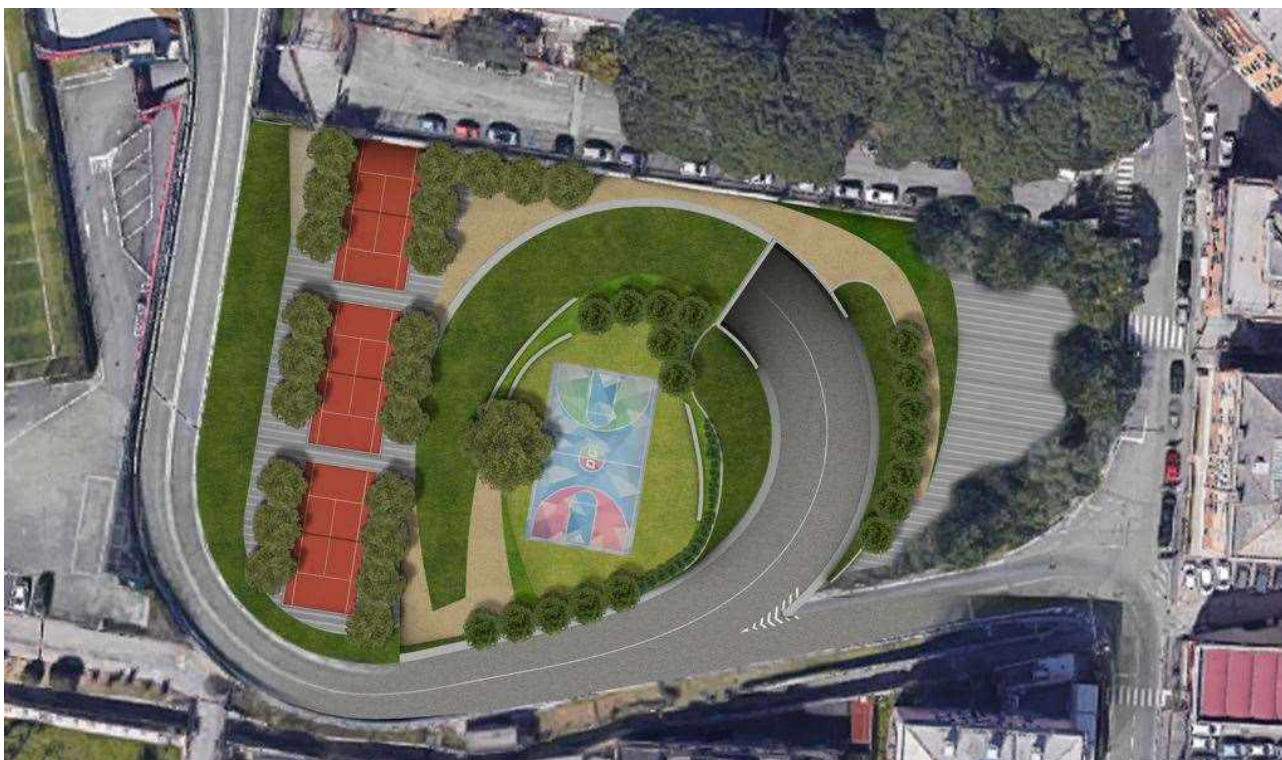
Foto inserimento area nord: connessione a svincolo autostradale e imbocco a 'monte' galleria artificiale
